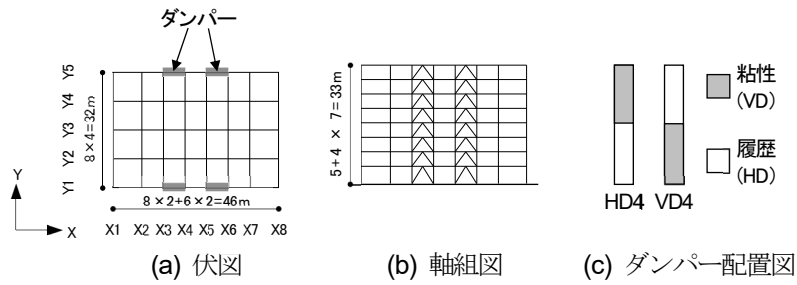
A.1 地上 8 階中低層鋼構造建物の伏図, 軸組図, ダンパー配置図
